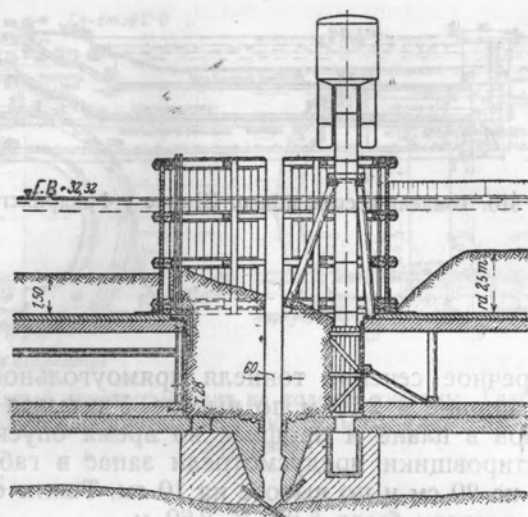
Нагнетание бетона под давлением в месте соединения обоих опущенных кессонов-тоннелей.
